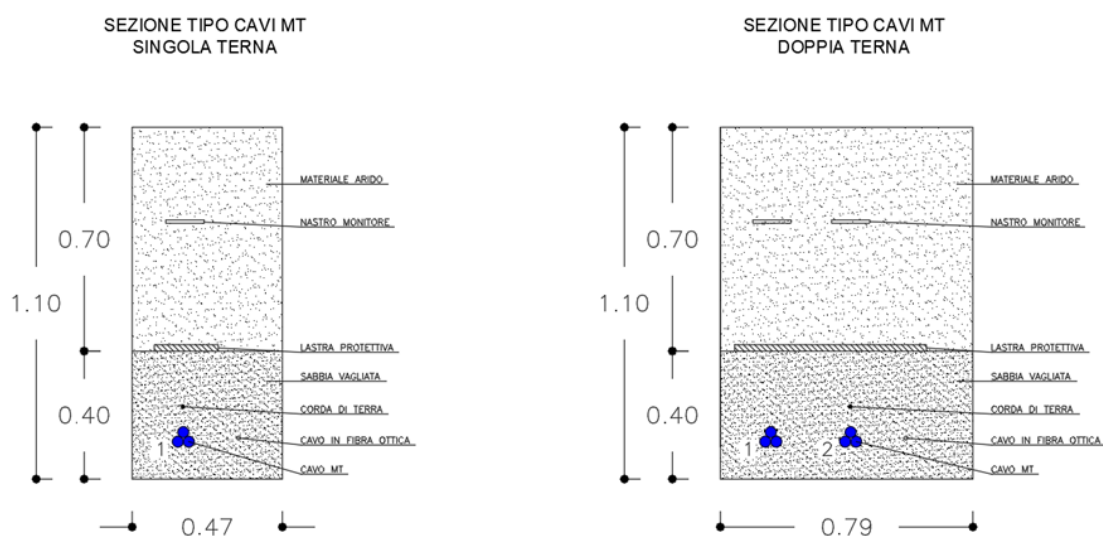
Sezione tipo scavi MT (singola terna e doppia terna)
